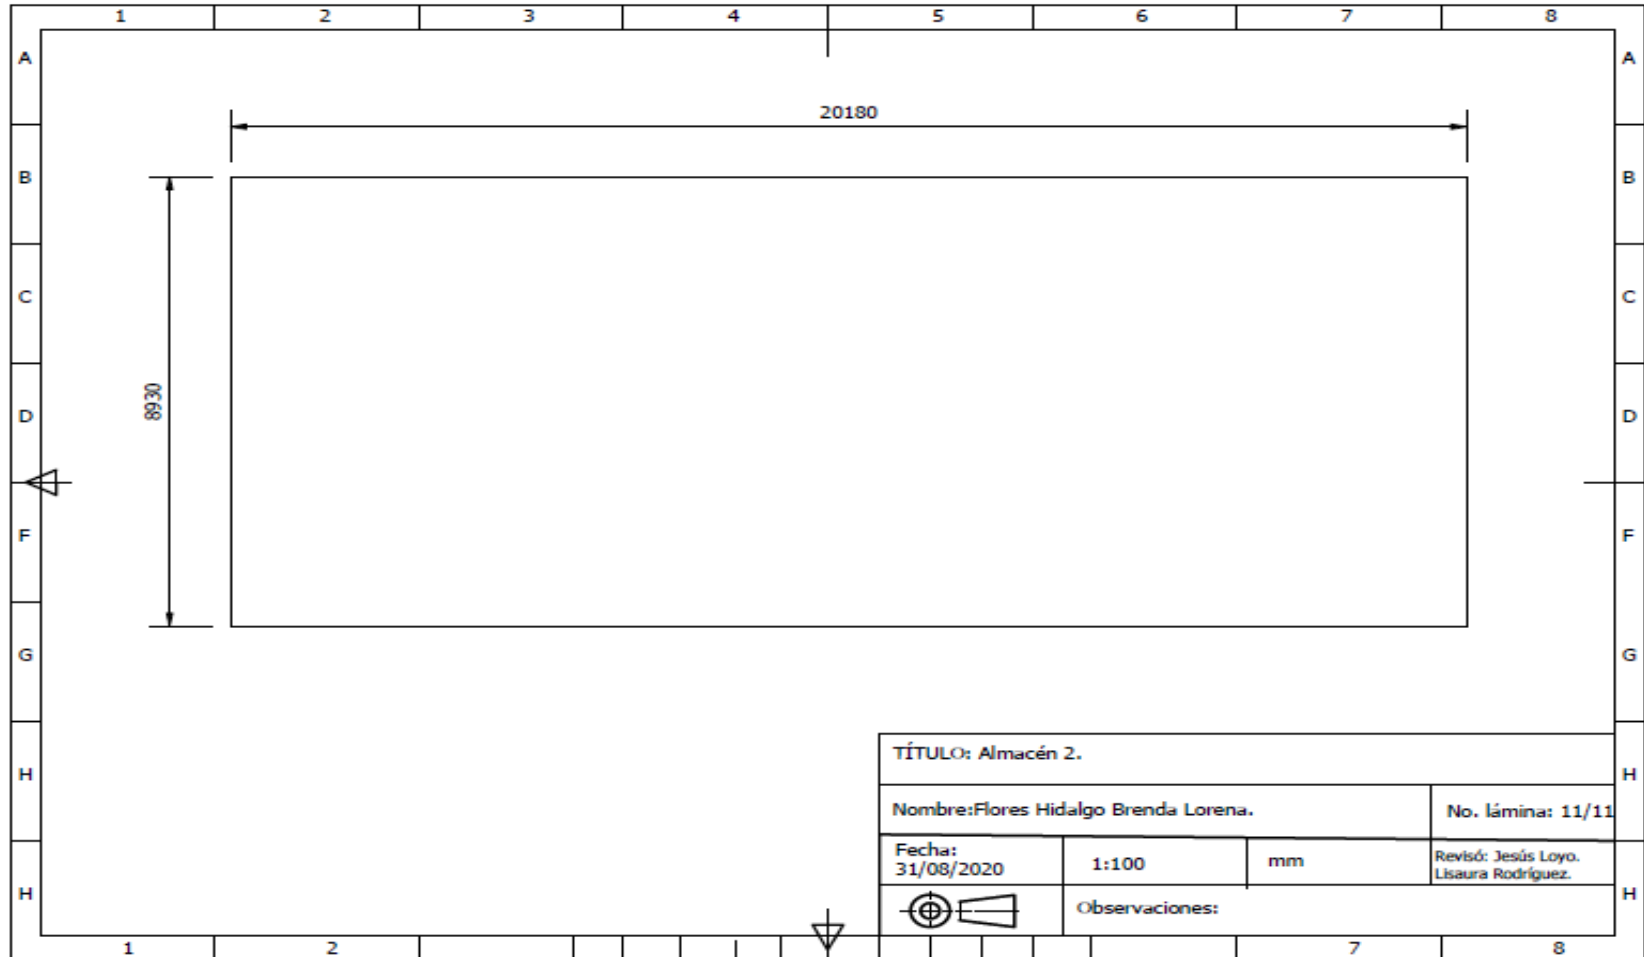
Plano del espacio requerido para el almacén 2. Fuente: Elaboración propia.
